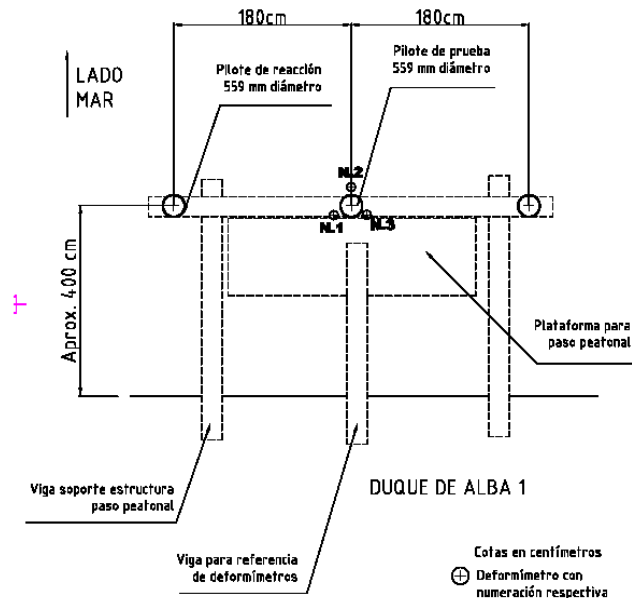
Arreglo de pilotes para prueba de carga vertical.
